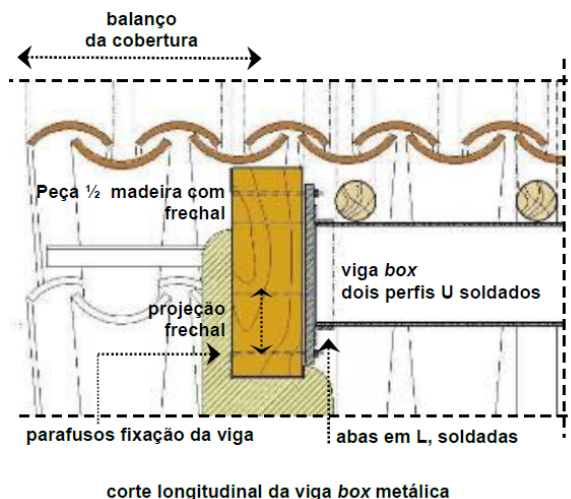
Detalhe de viga-box metálica intermediária nos grandes vãos da casa-grande (Muñoz; Muraro, 2013, p.20)
